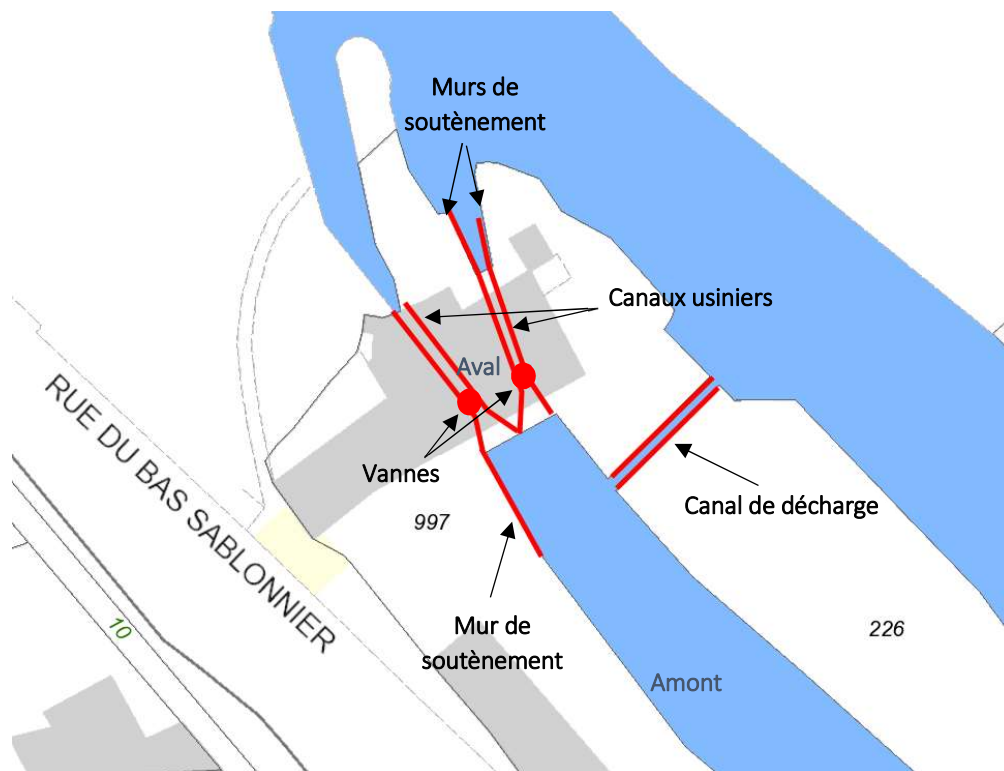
en rouge, ouvrages hydrauliques concernés par les travaux (canaux usiniers, canal de décharge, vannes et murs de soutènement)
